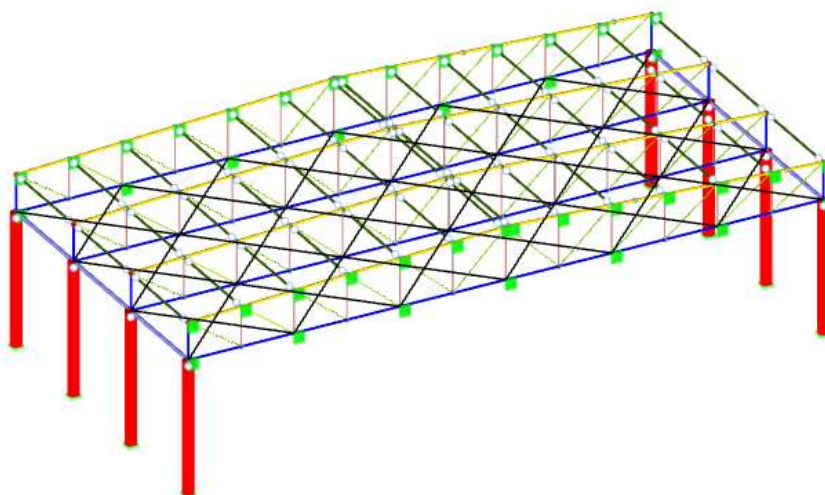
Cruces de San Andrés situadas en el plano horizontal de la celosía
